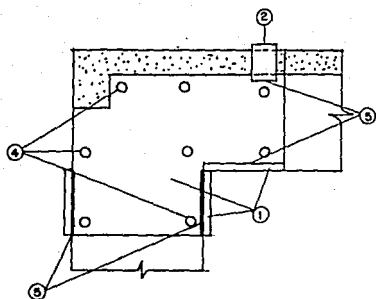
Encamisado metálico de columnas (Ref. 15 y 16)
